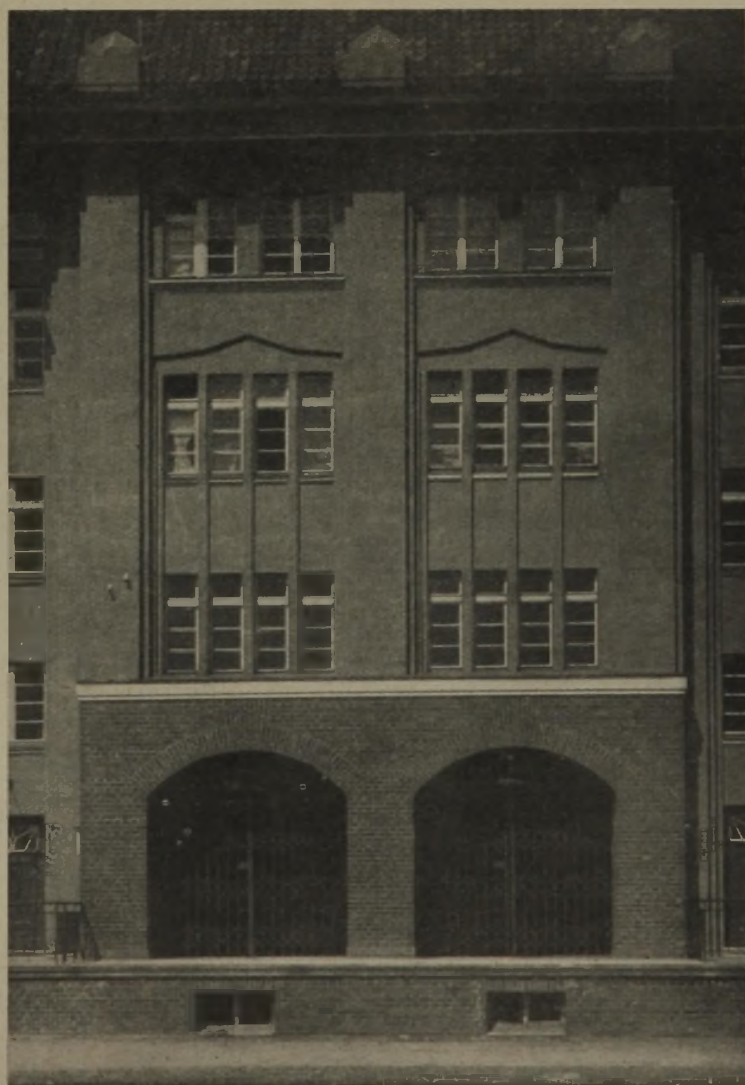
(oben). Lagerhalle II mit Bürogebäude-Anbau (Wasserseite).
